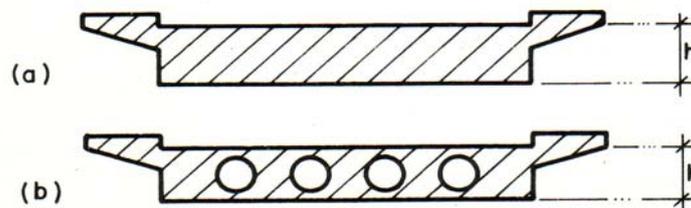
Esquemas de ponte em laje (MASON, 1977).
